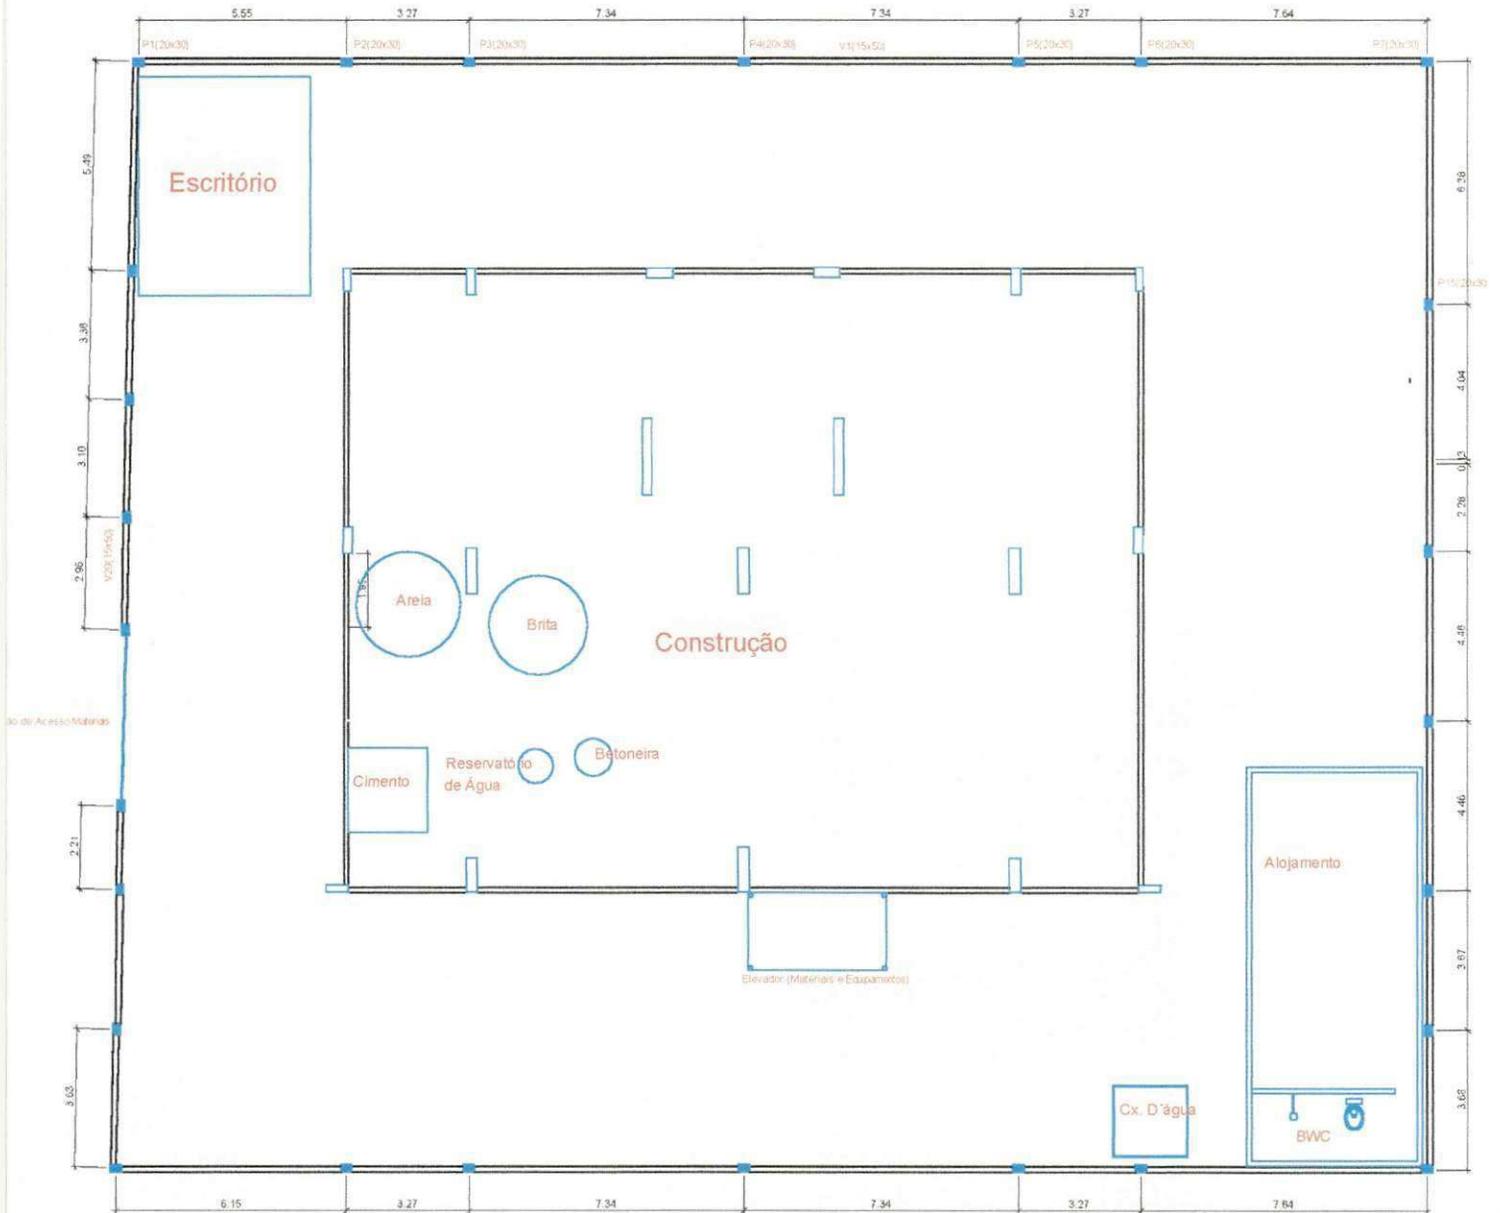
Layout do canteiro de obras (Fonte: Consólid 2002).
